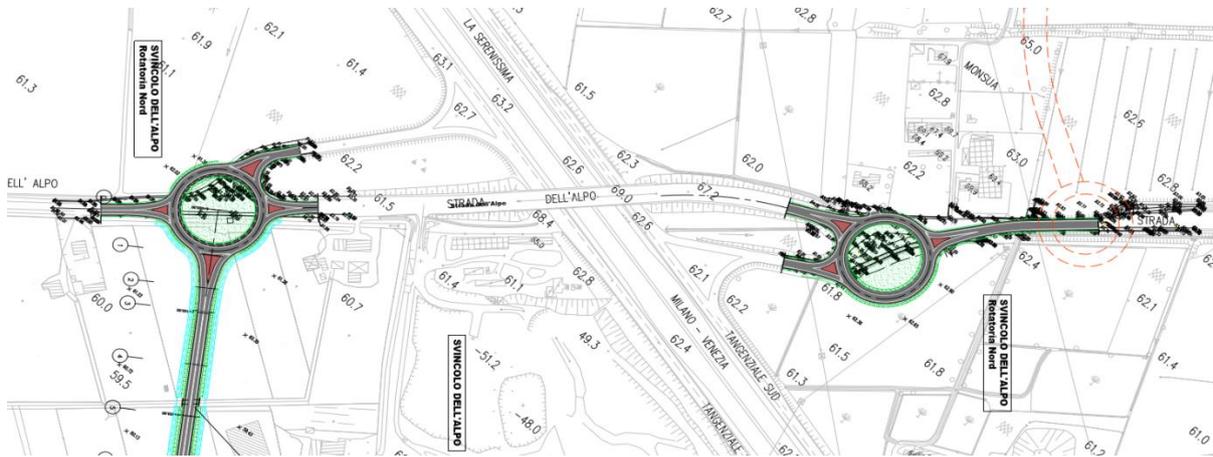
Svincolo dell'Alpo - Rotatoria nord e sud – Planimetria
